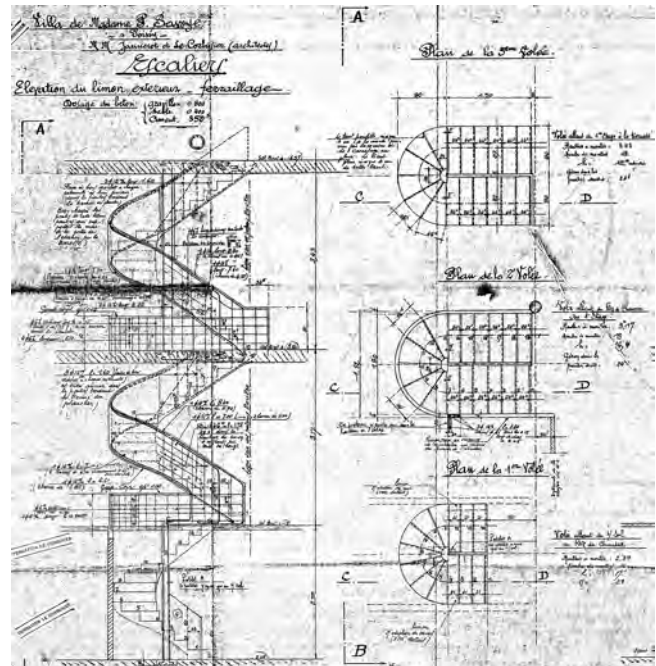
Detalle del plano de estructura de la escalera de la *Villa Savoye* (FLC-HI-13-314). Fuente: Fondation Le Corbusier.
